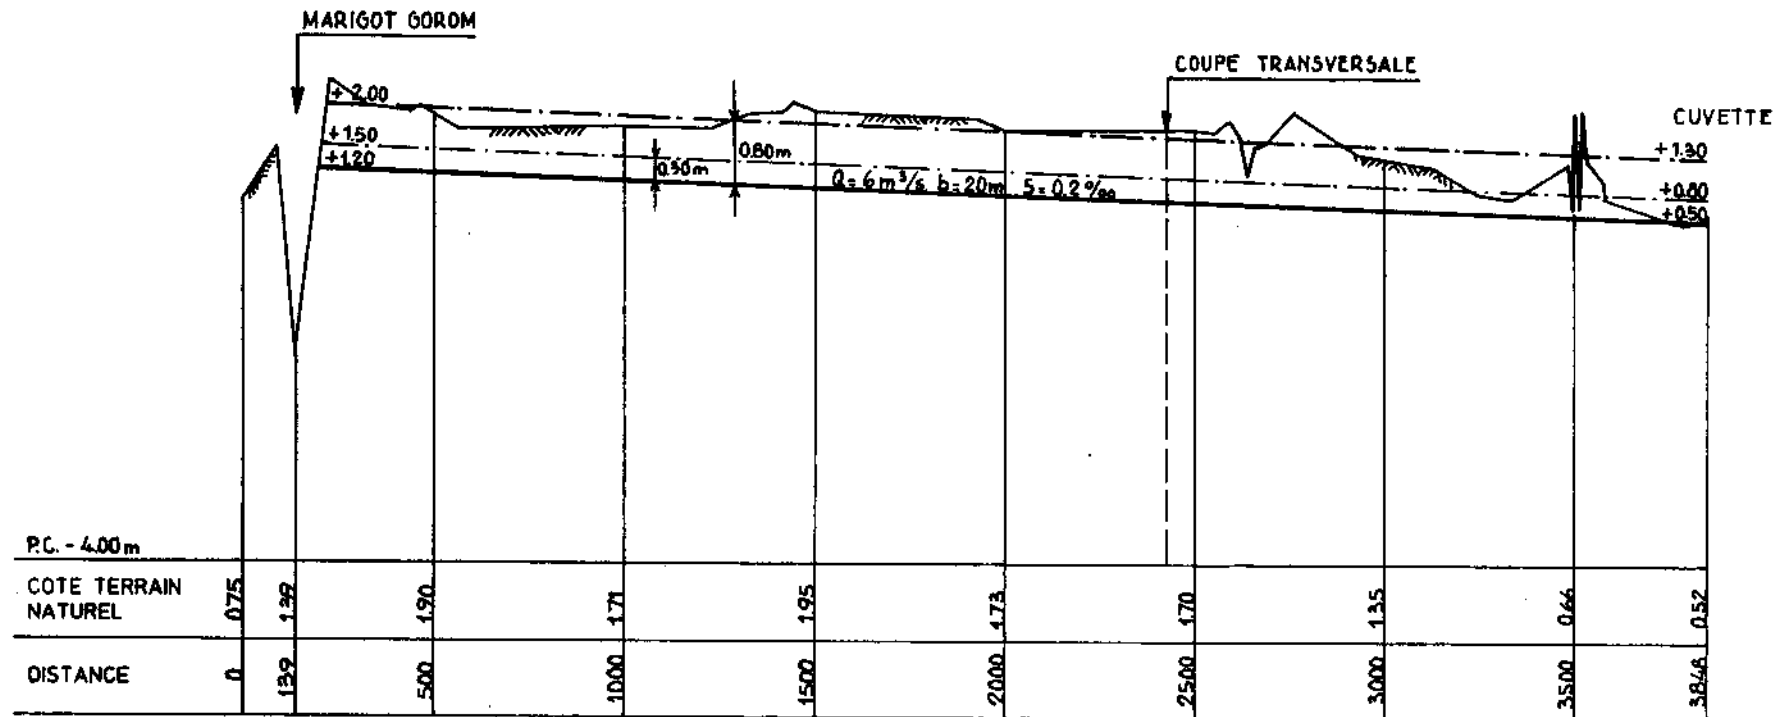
DRAIN D'EXHAURE PROJETE , PROFIL LONGITUDINAL
